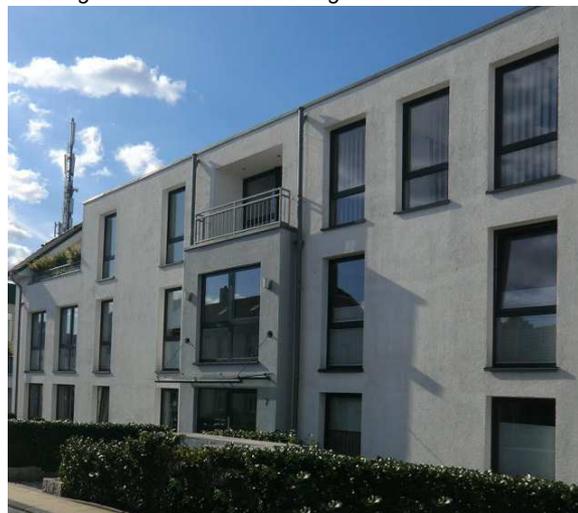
Geschossbau mit regelmäßiger Lochfassade
